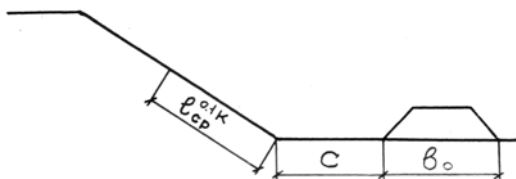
Схема к определению среднего расстояния перемещения растительного грунта на откос
